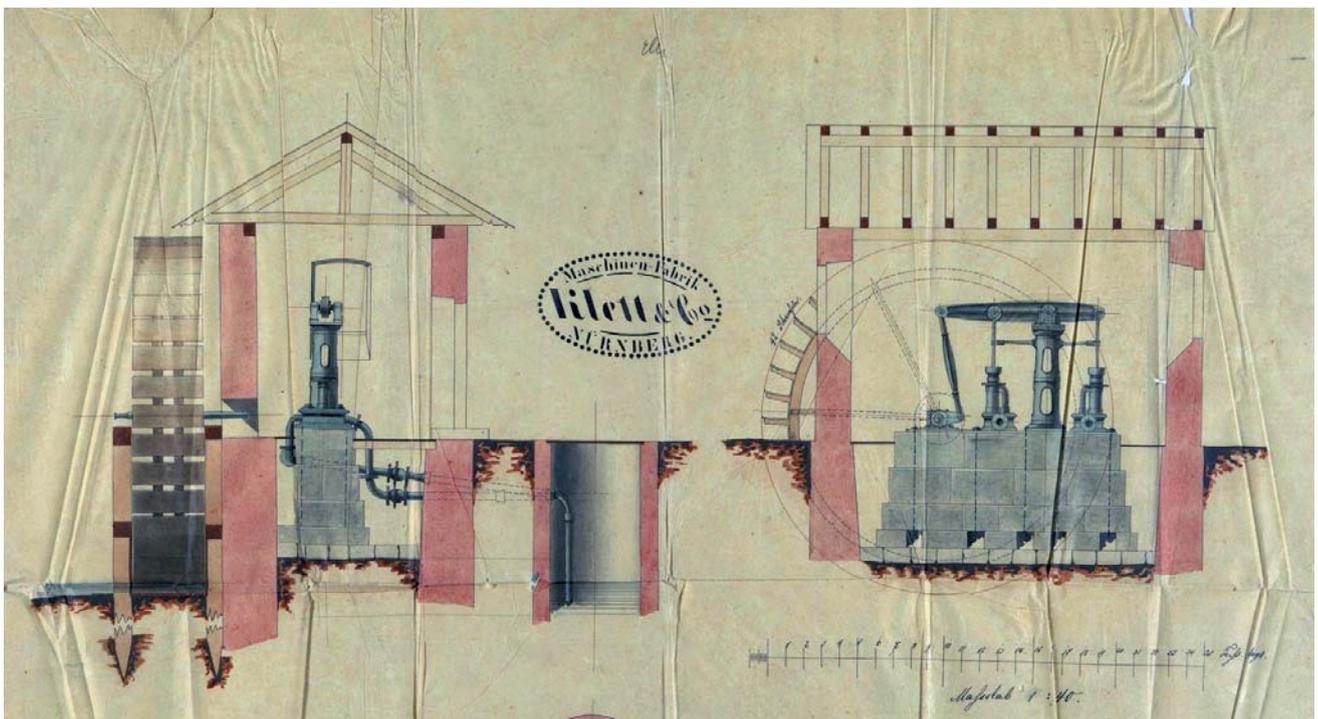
Plan der Firma Cramer-Klett zur Pumpanlage. Ausschnitt
